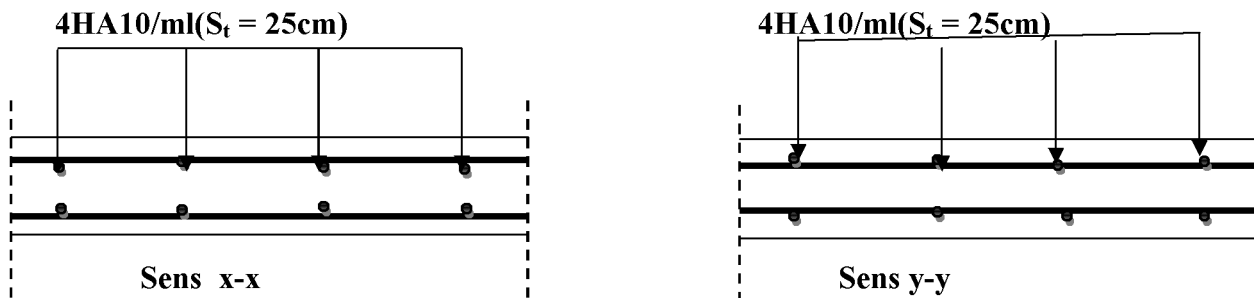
Ferrailage de la dalle pleine de la salle machine.
